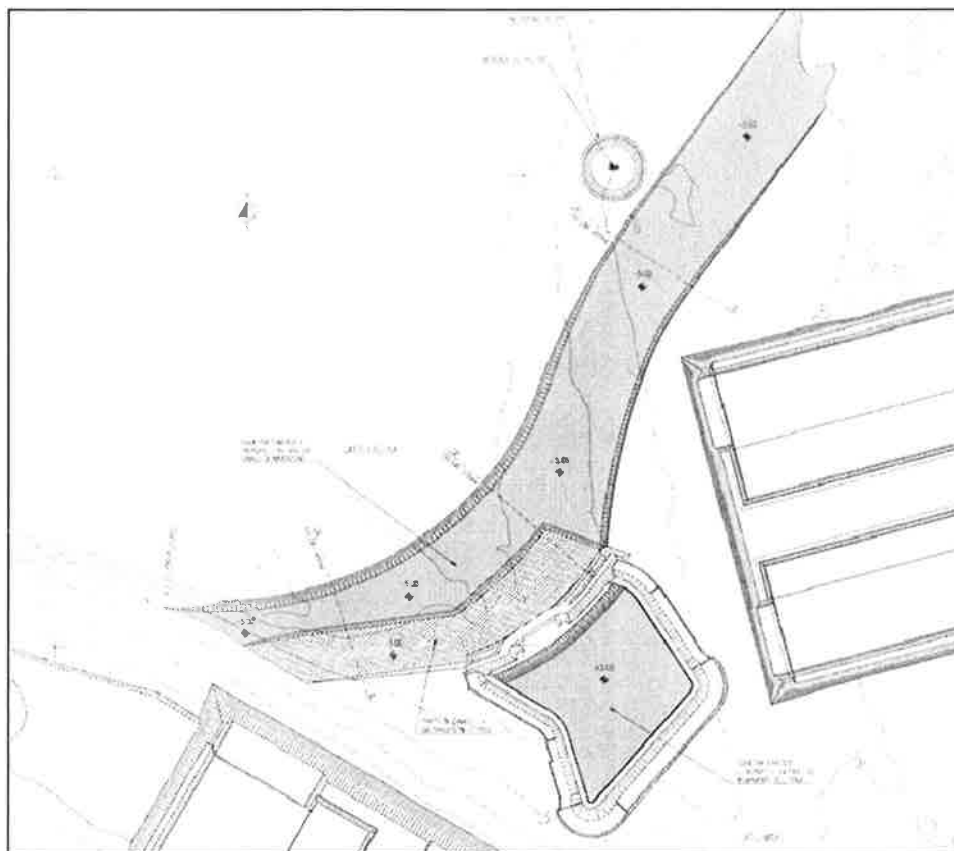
PLANIMETRIA GENERALE DELLE OPERE
